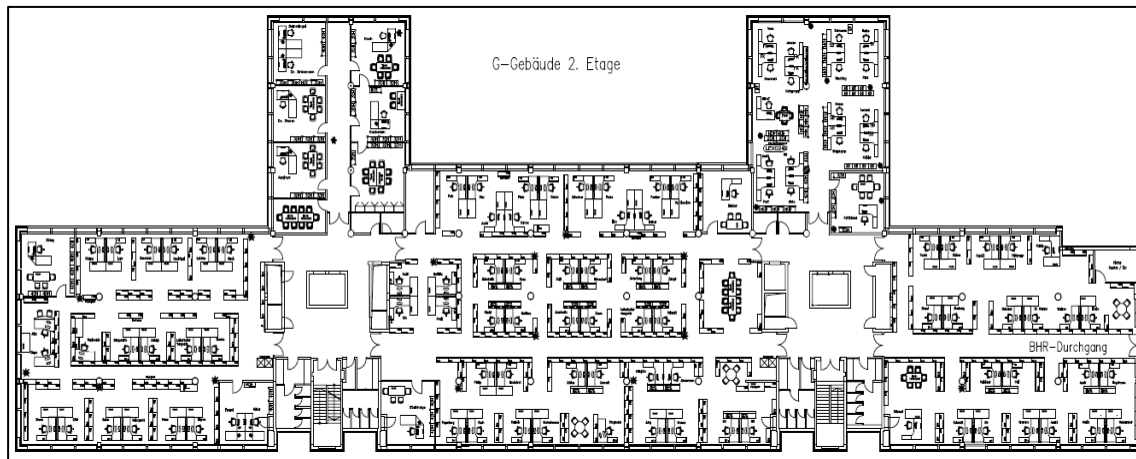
Grundriss eines Regelgeschosses der alten Büroumgebung⁸⁹³
